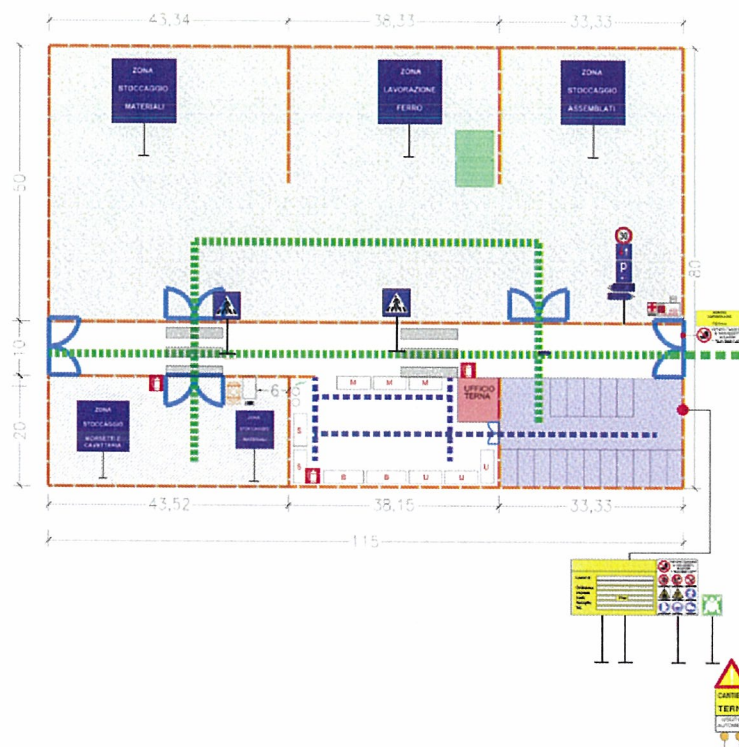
schema dell'area centrale di cantiere prevista dal PSC
